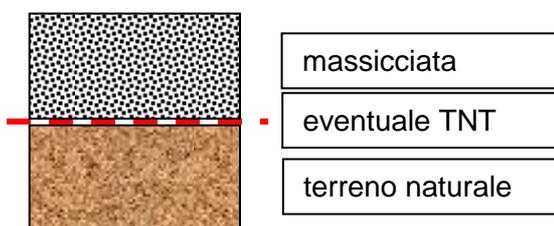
Schema di realizzazione pista di cantiere Tipo I.
